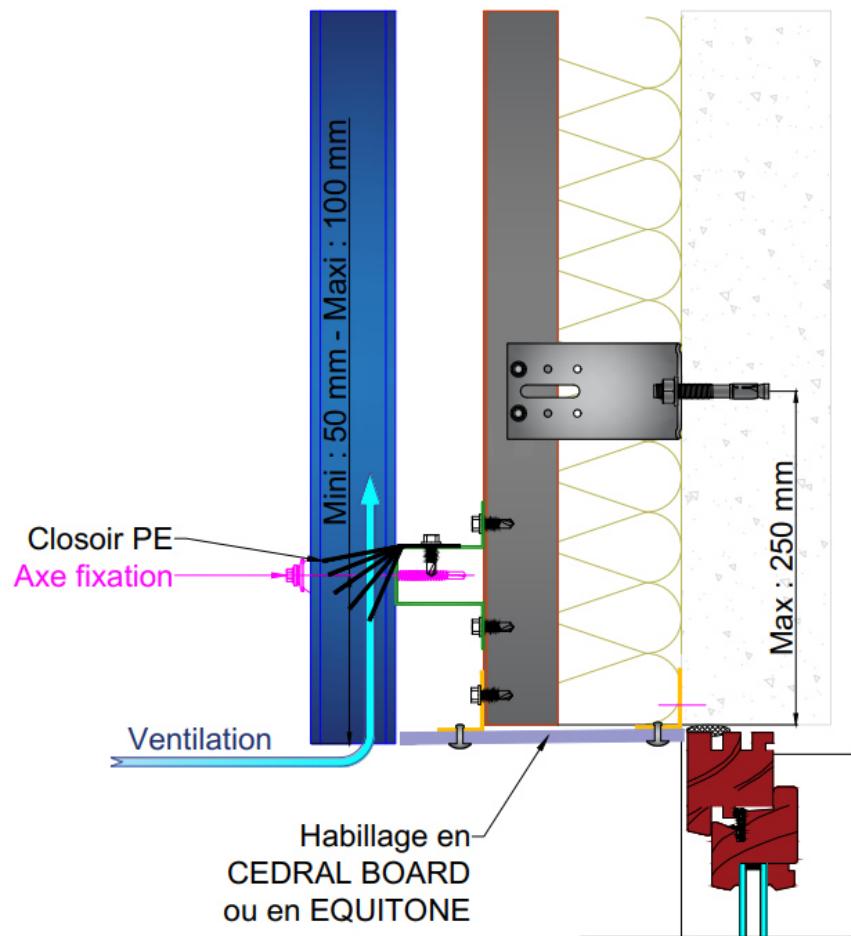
Linteau de baie avec panneau CEDRAL BOARD ou EQUITONE
